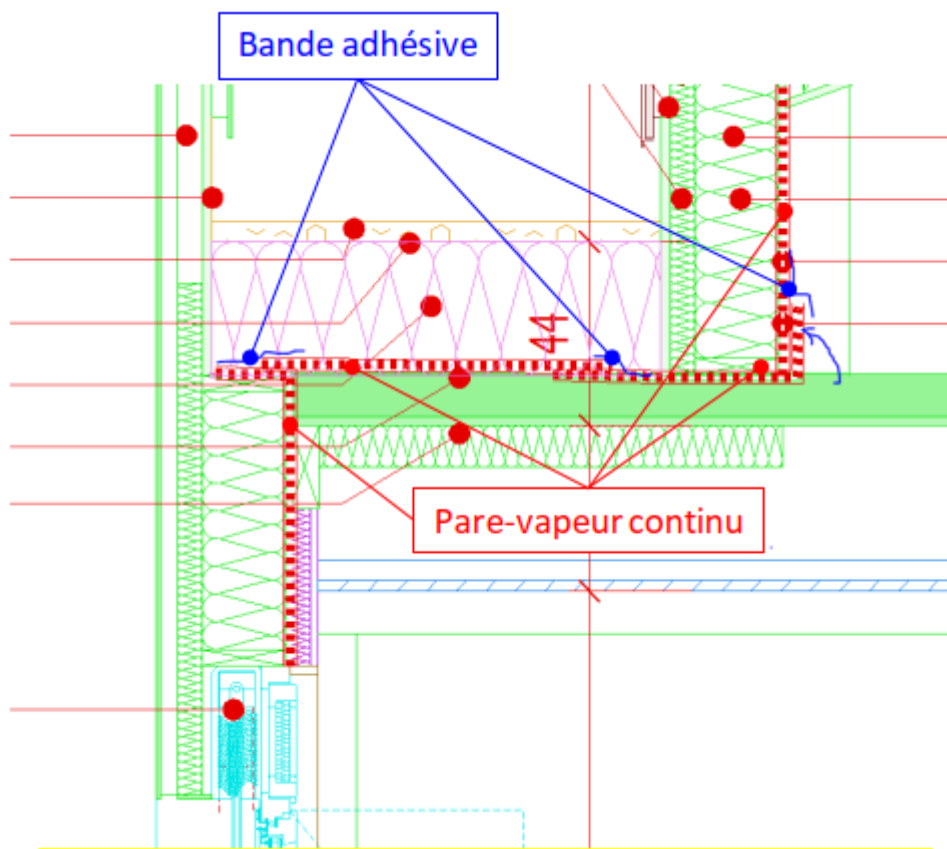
Etanchéité du collège, détails parois rez-de-chaussée et R+1
